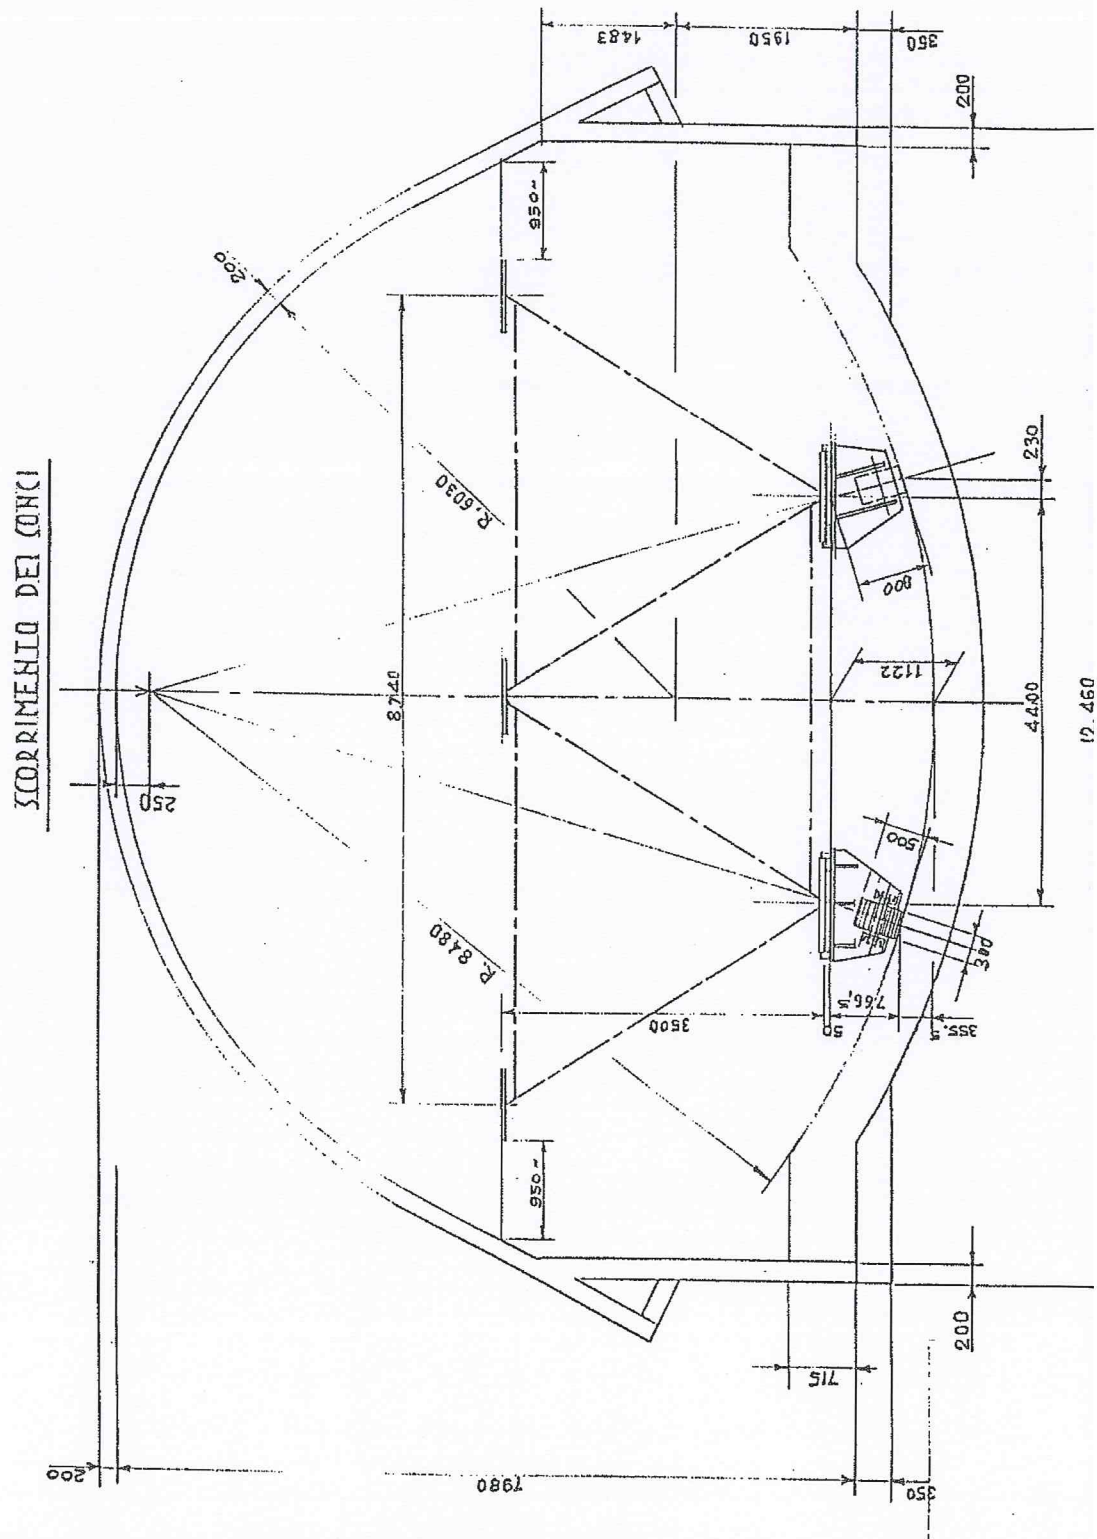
Sezioni in galleria - Cross sections in tunnel
